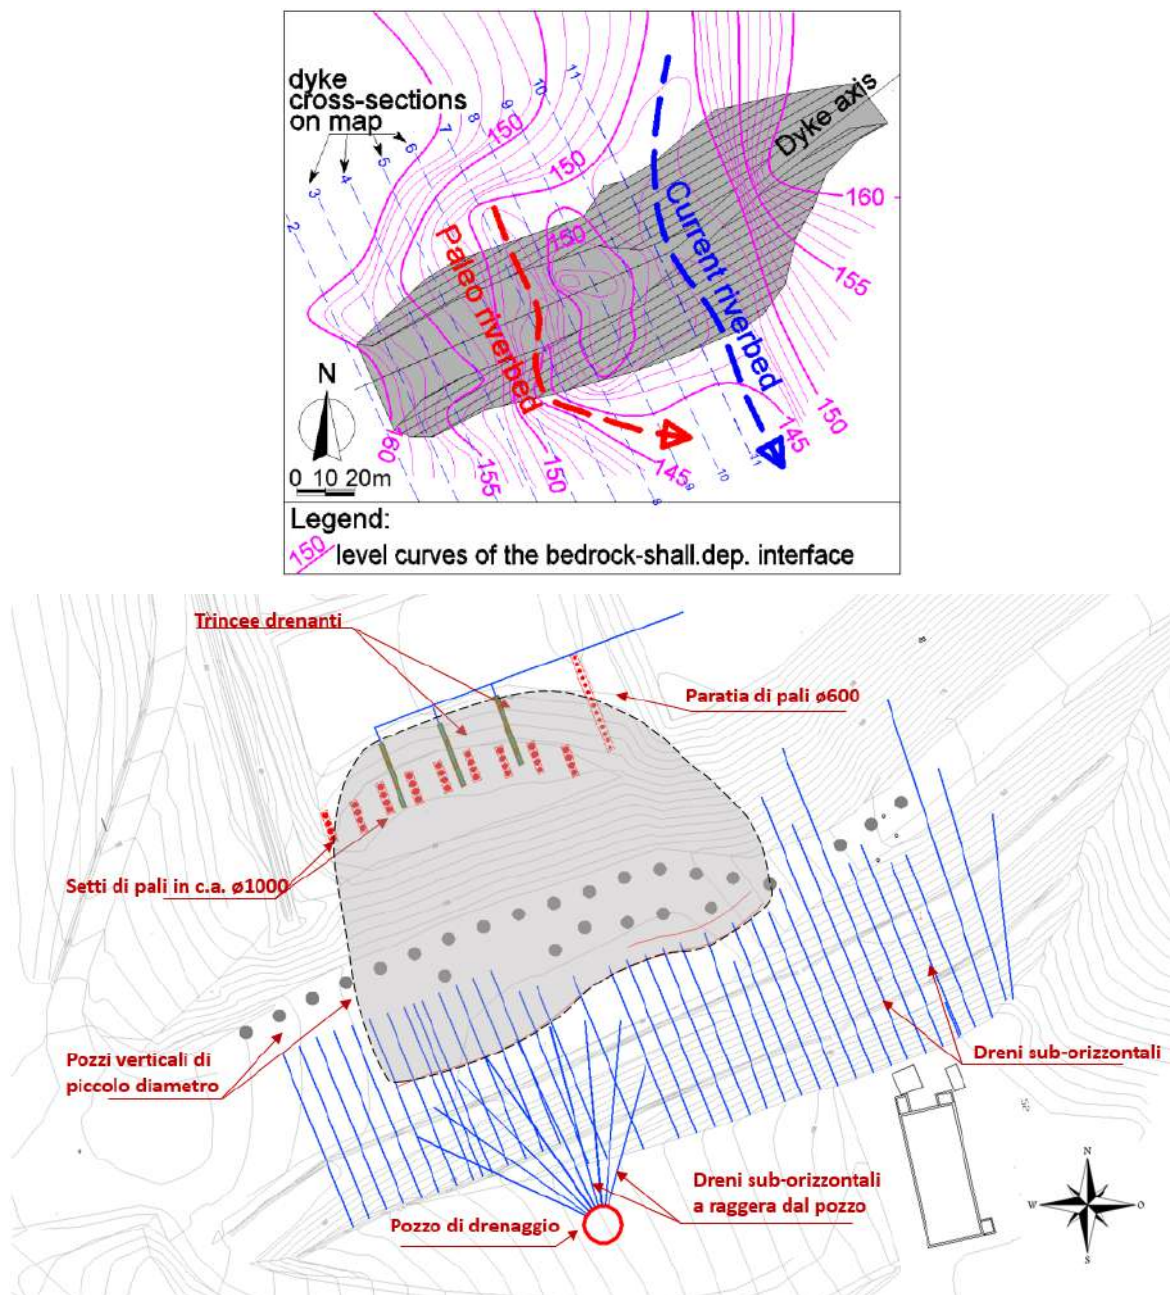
Planimetria dell'area con indicazione del Paleoalveo e degli interventi di consolidamento
